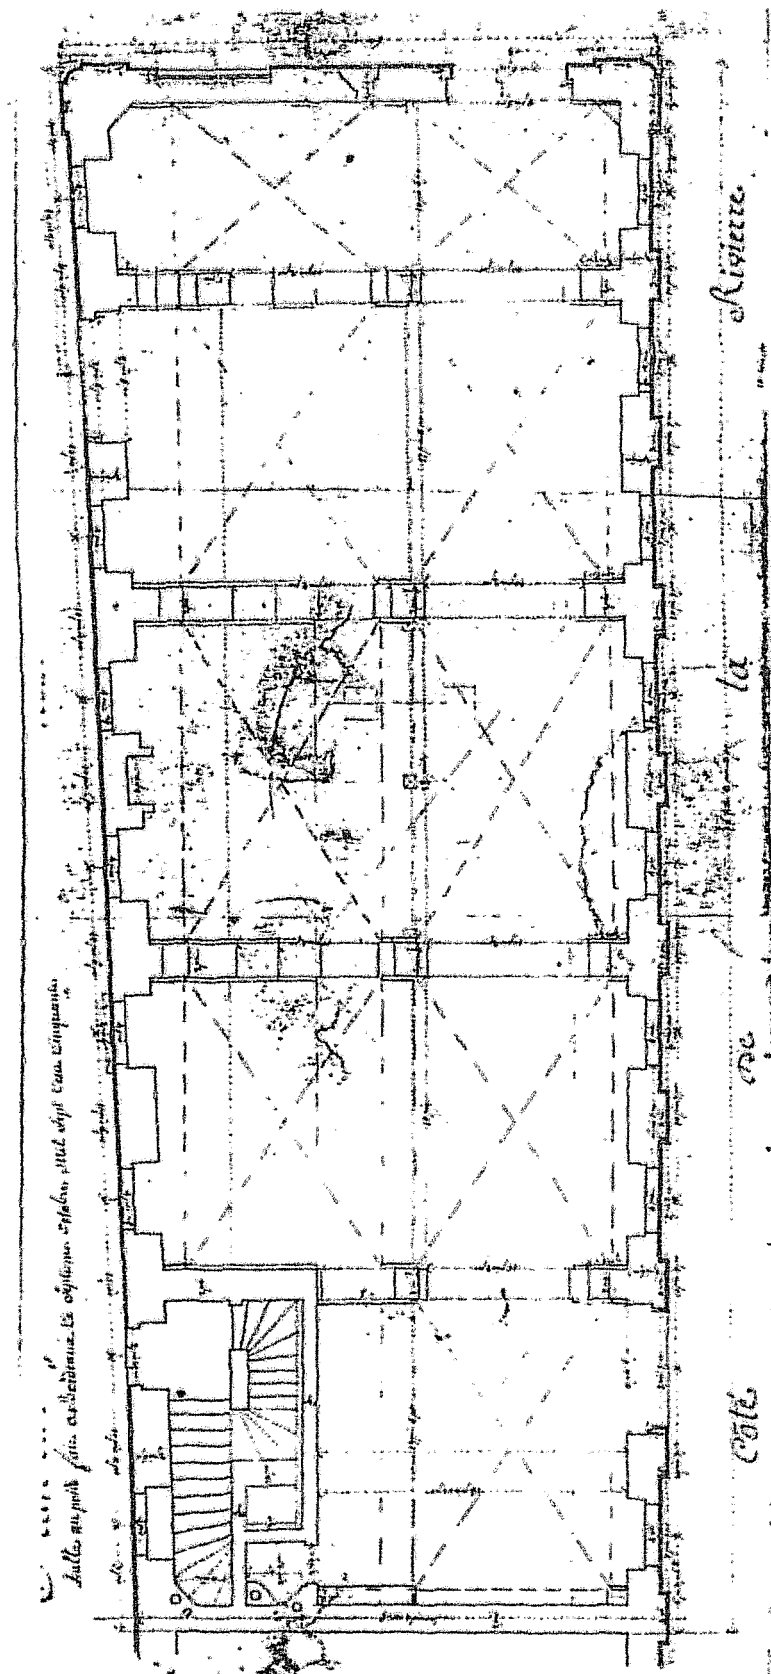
Plan du rez-de-chaussée de la Halle aux Poids avant agrandissement
